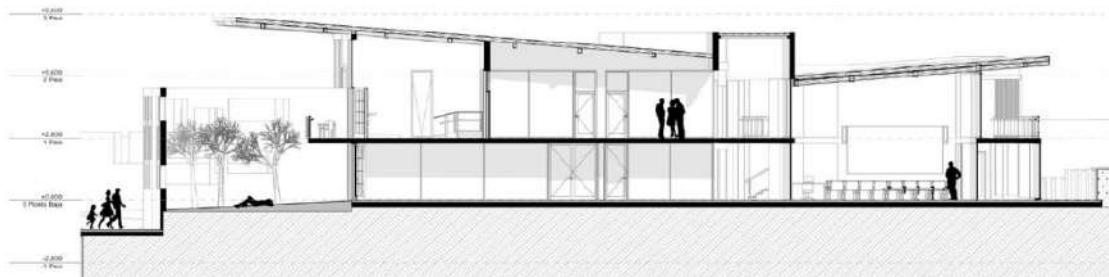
Fachadas principales y corte por perímetro libre jardines de sanación.
